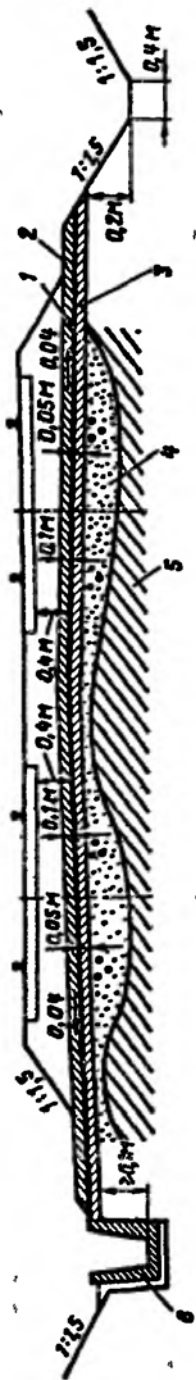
Схема конструкции гидроизоляционного покрытия на двухслойном участке: 1 — гидроизоляция; 2, 3 — верхний и нижний защитные слои; 4 — невырезанная часть старого балласта; 5 — глинистый грунт; 6 — лоток
